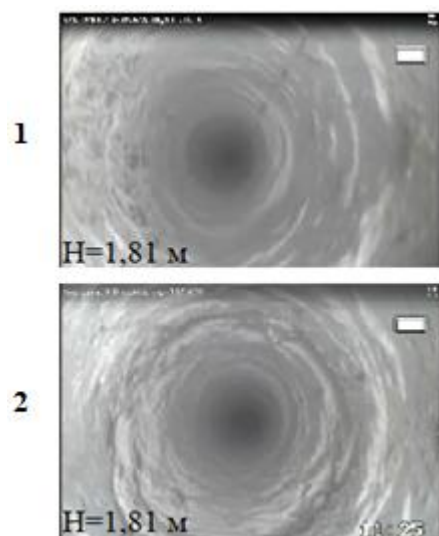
Исследования кровли выработок видеоэндоскопом
